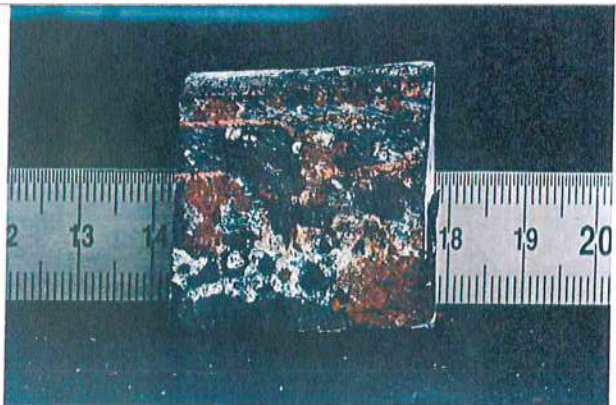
LARGHEZZA DEL CAMPIONE
